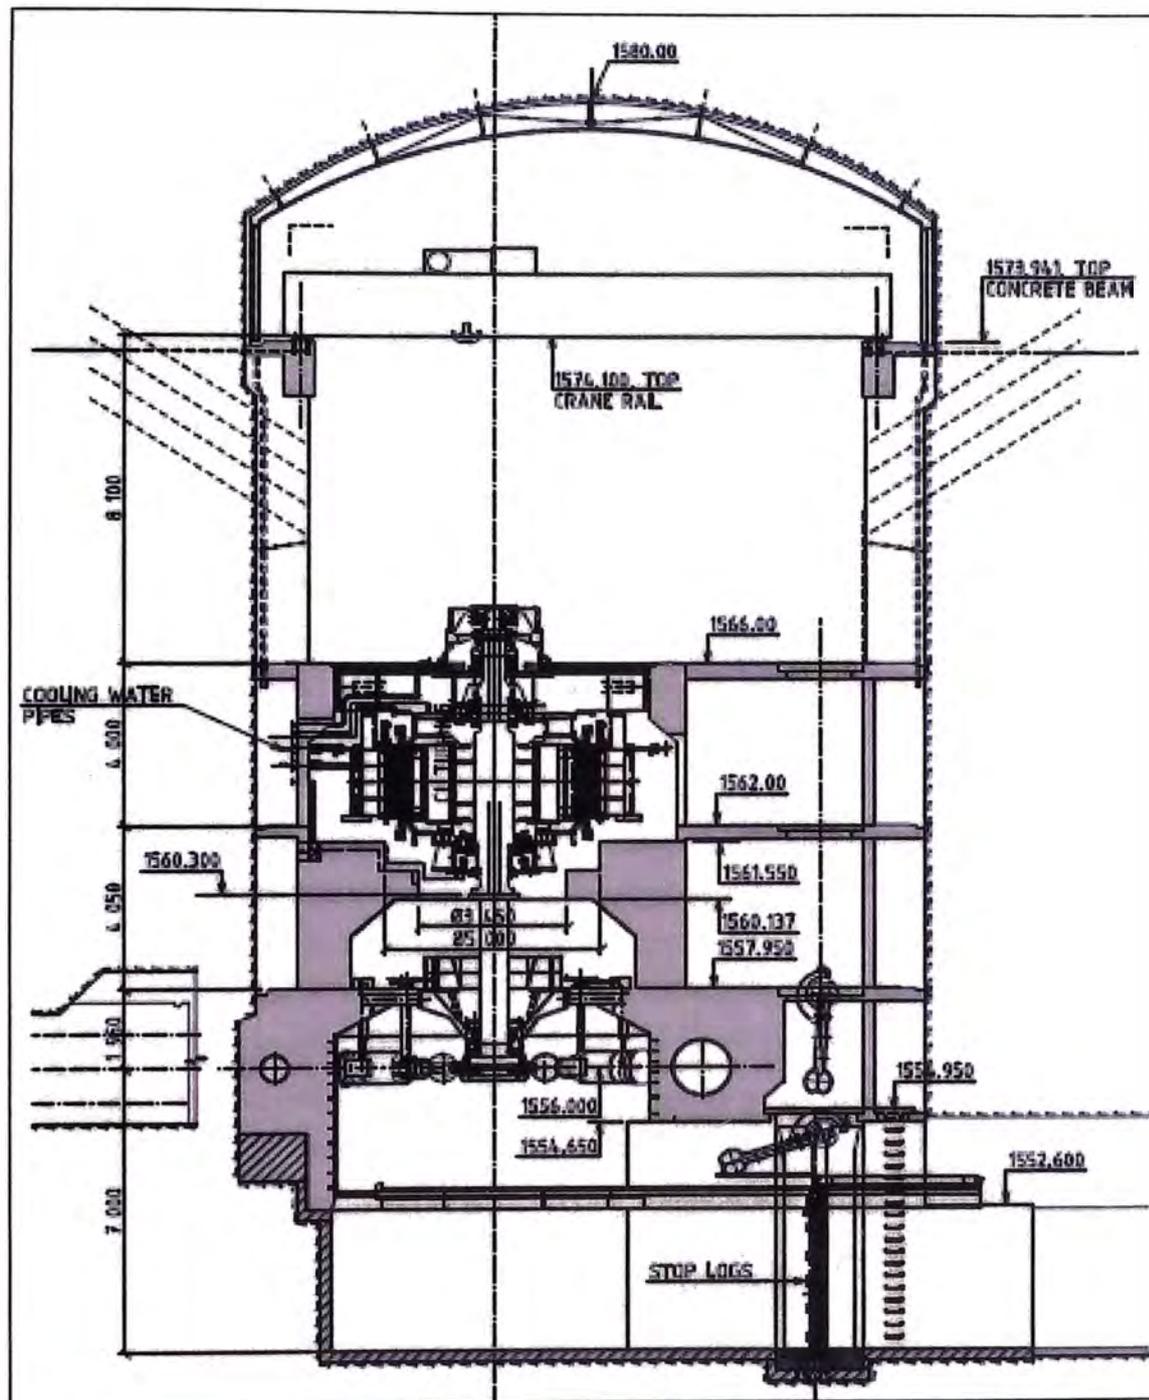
Plano en corte casa de máquinas C.H. Liple
